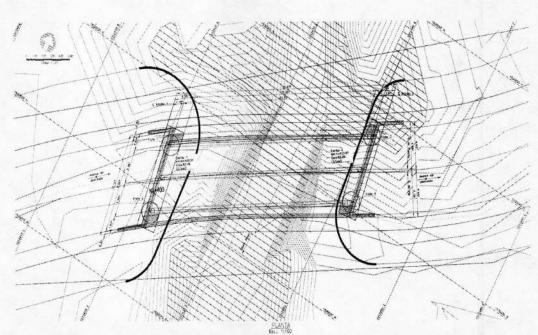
Vista en planta de la obra propuesta jurisdicción del municipio de Chimichagua.
